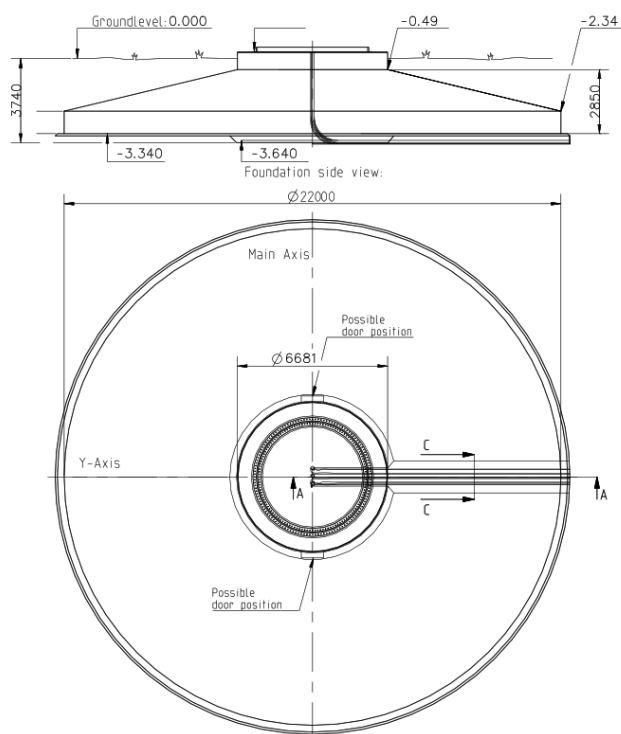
Cimentación propuesta, pendiente de verificar tras estudio geotécnico
